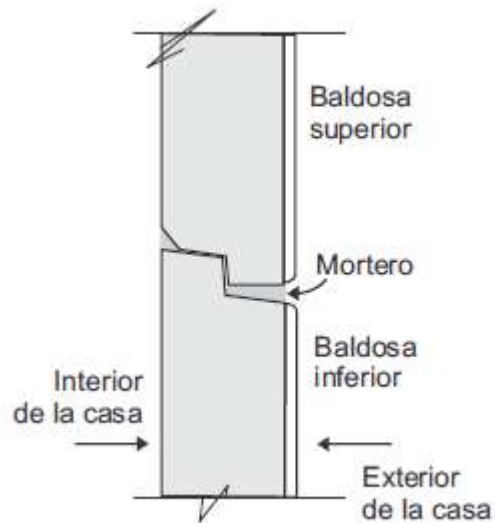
Detalle de juntas entre baldosas - Prefa PC - 2021.
